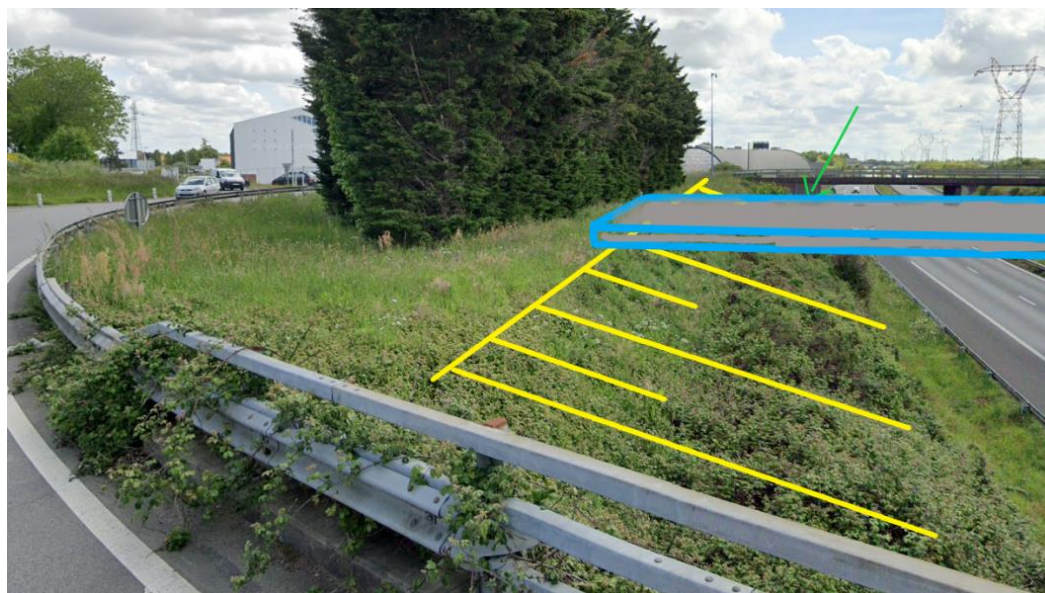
Plan d'implantation du franchissement du périphérique en scénario 1 (SYSTRA)
